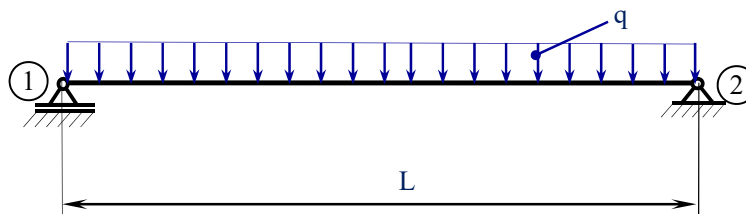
Modul de încărcare a panoului tip sandwich
